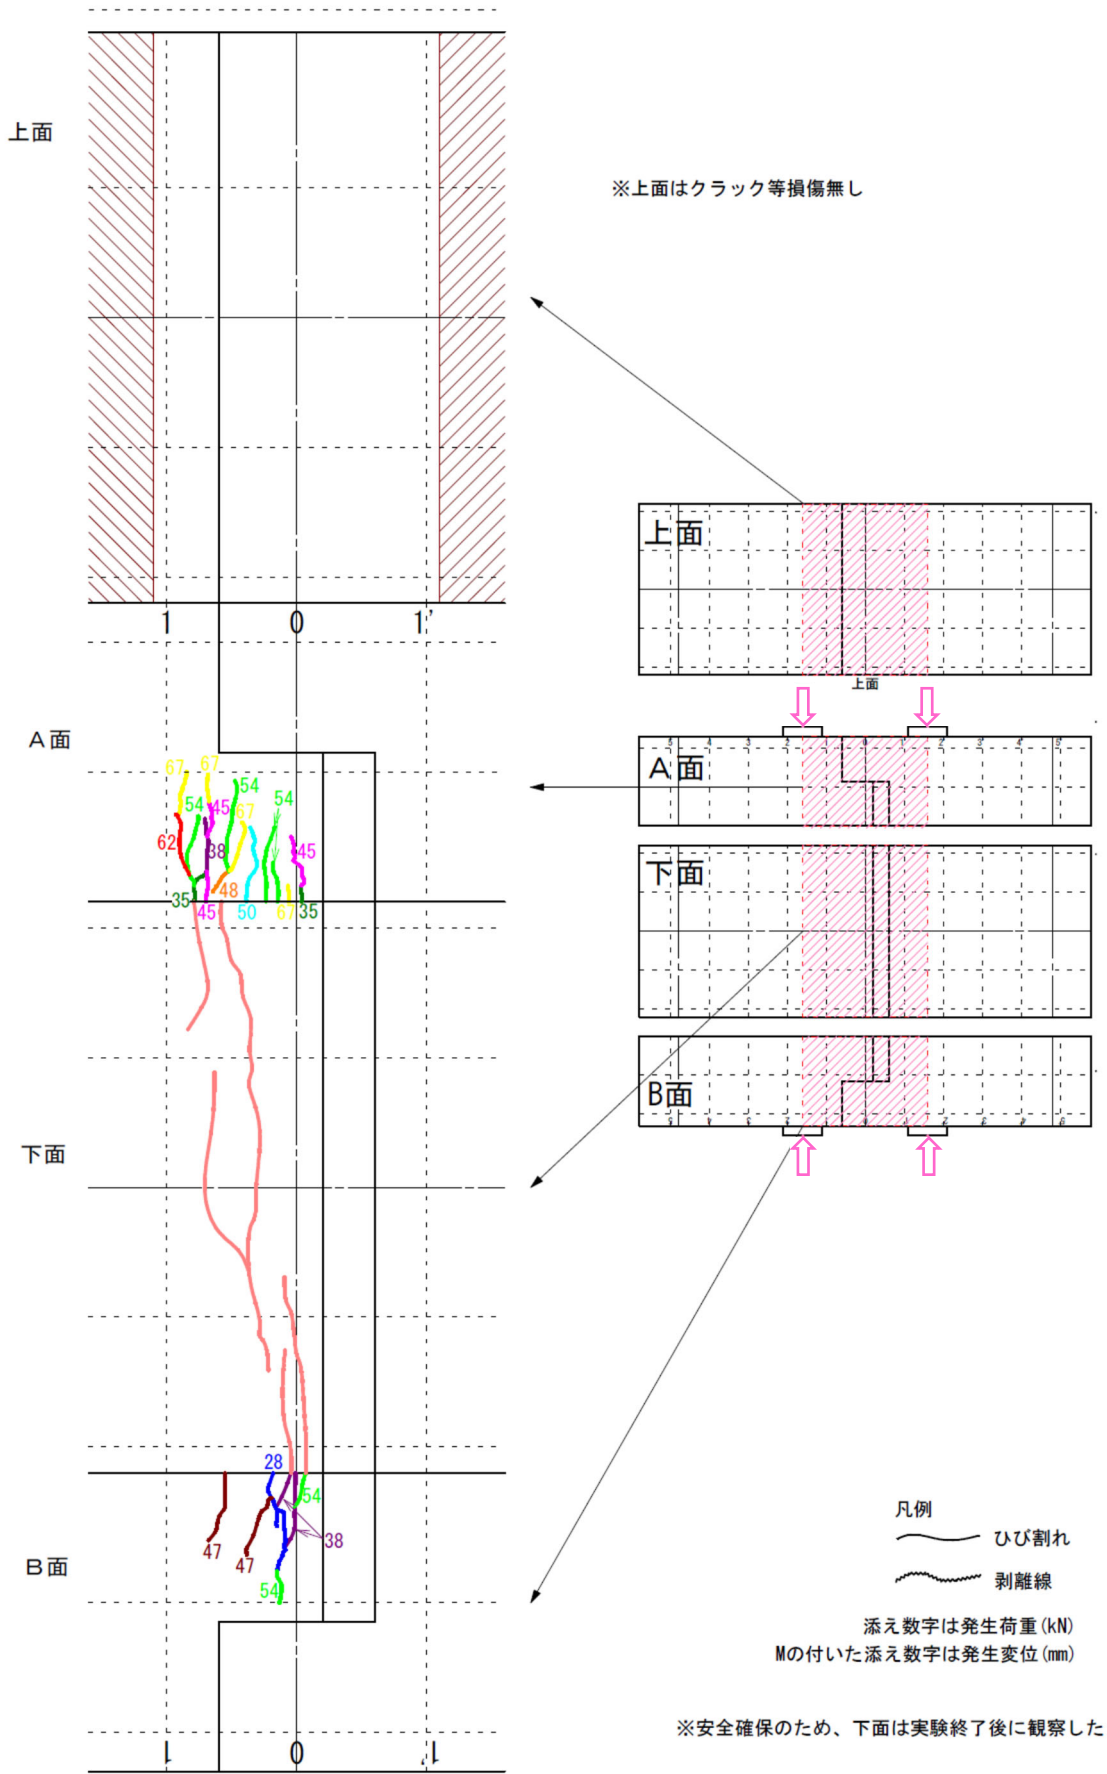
ひび割れ図 (供試体 KF1-2)
